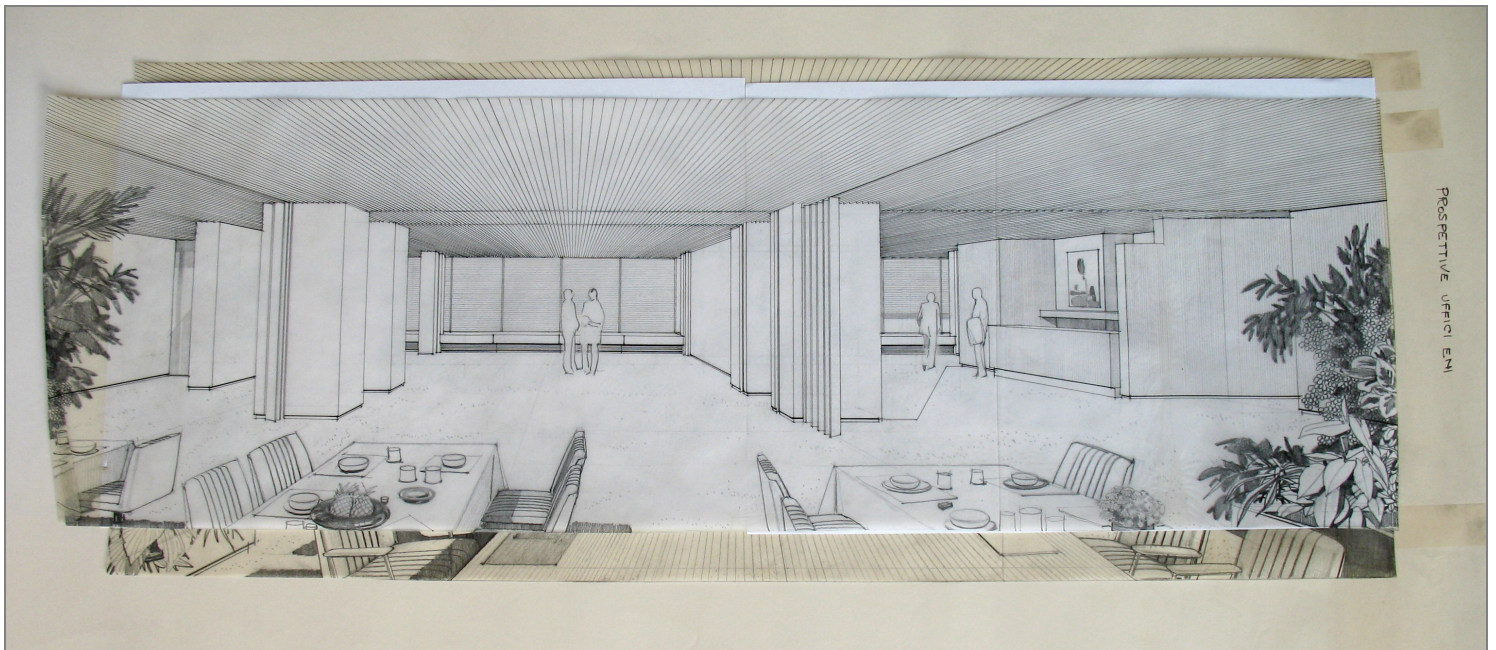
vista prospettica - mensa (fonte CSAC , archivio n. 70-3)
